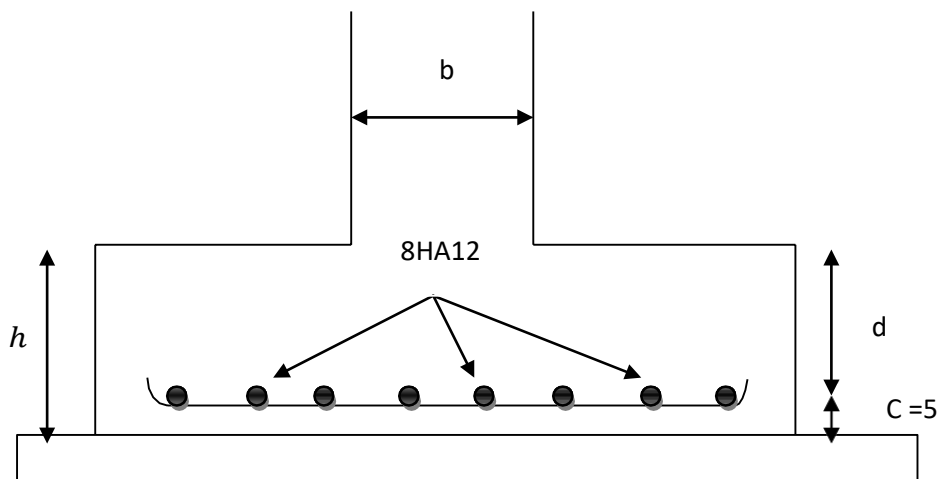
Dimension des semelles et disposition constructive des armatures
